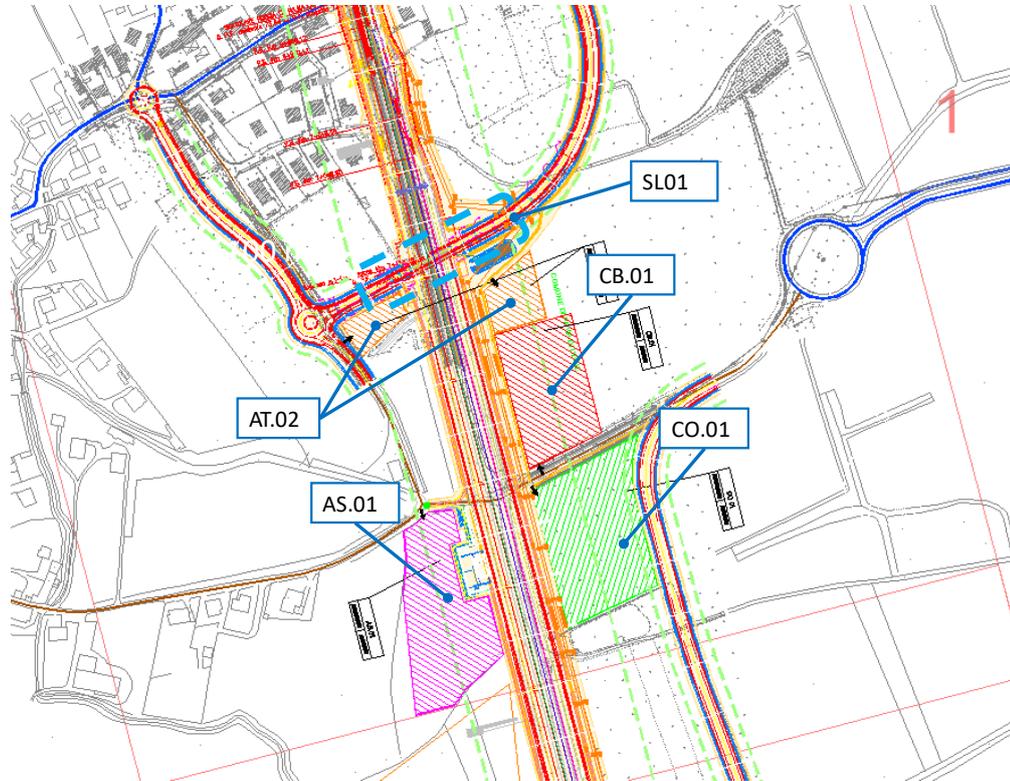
Localizzazione delle aree di cantiere e attività di lavorazione
